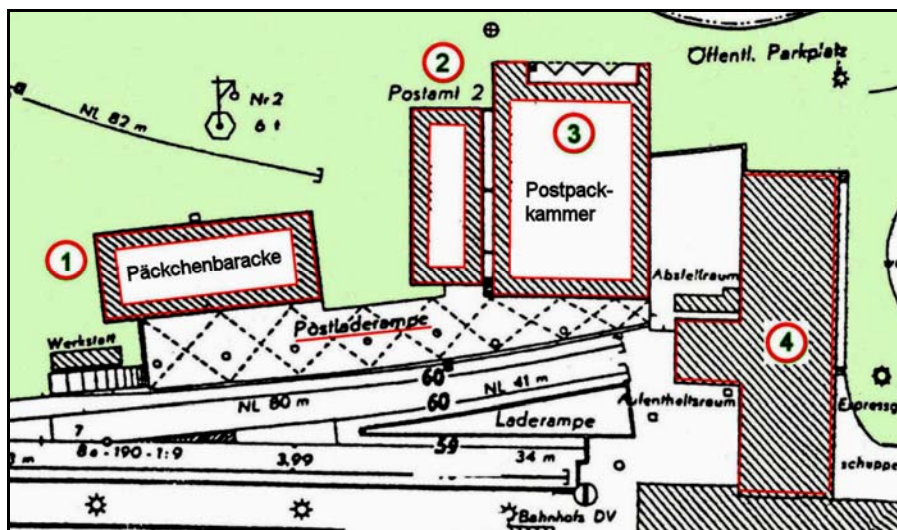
Die Gebäude an der Postladerampe neben dem Hauptbahnhof
